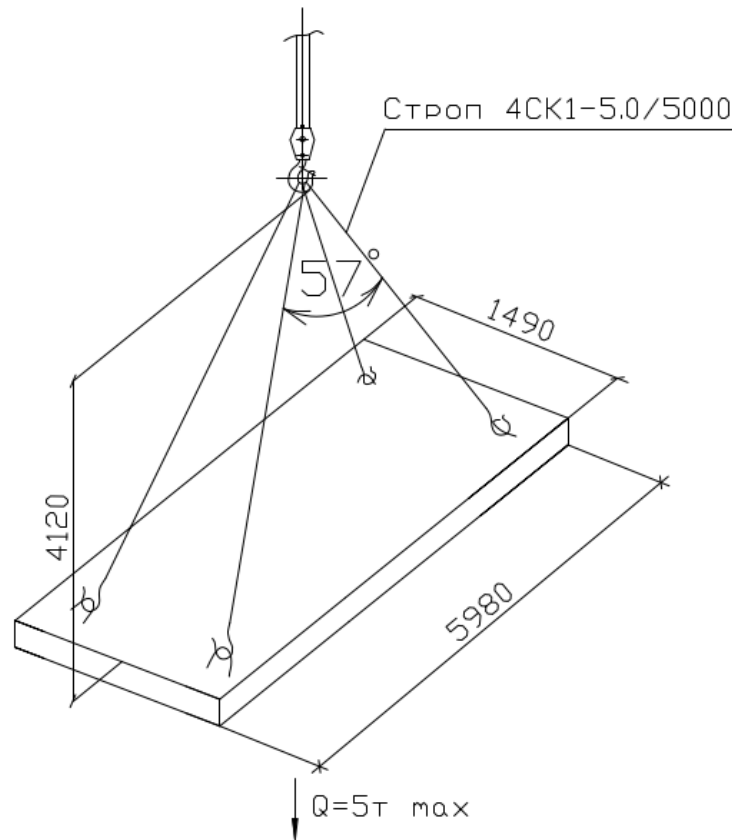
Схема строповки плиты перекрытия ПК 60.15-8AmVT
